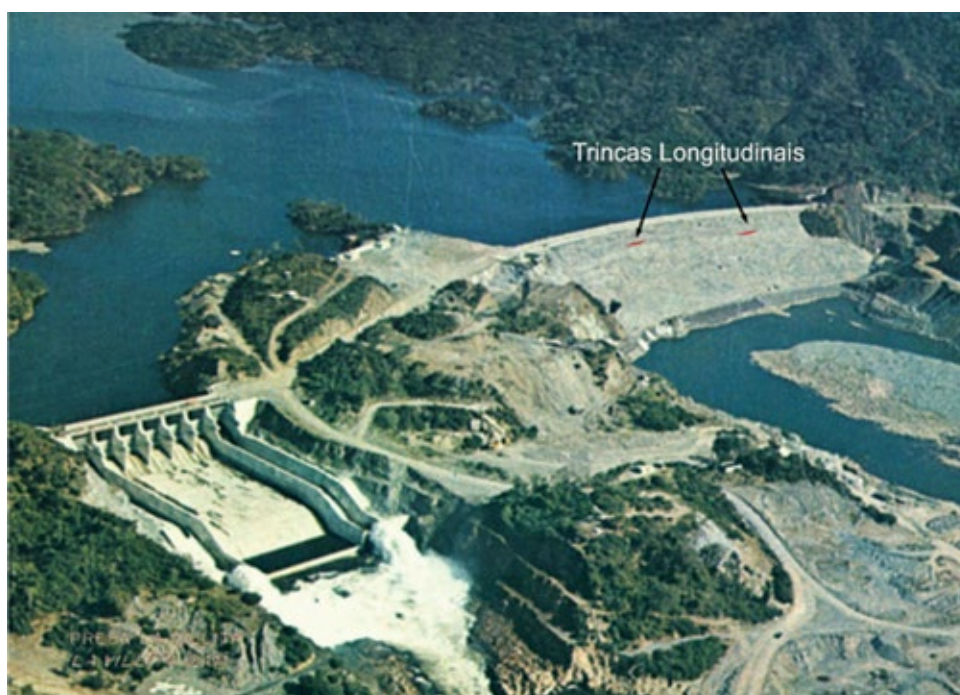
Fissuras longitudinais na barragem de El Infiernillo (México).
